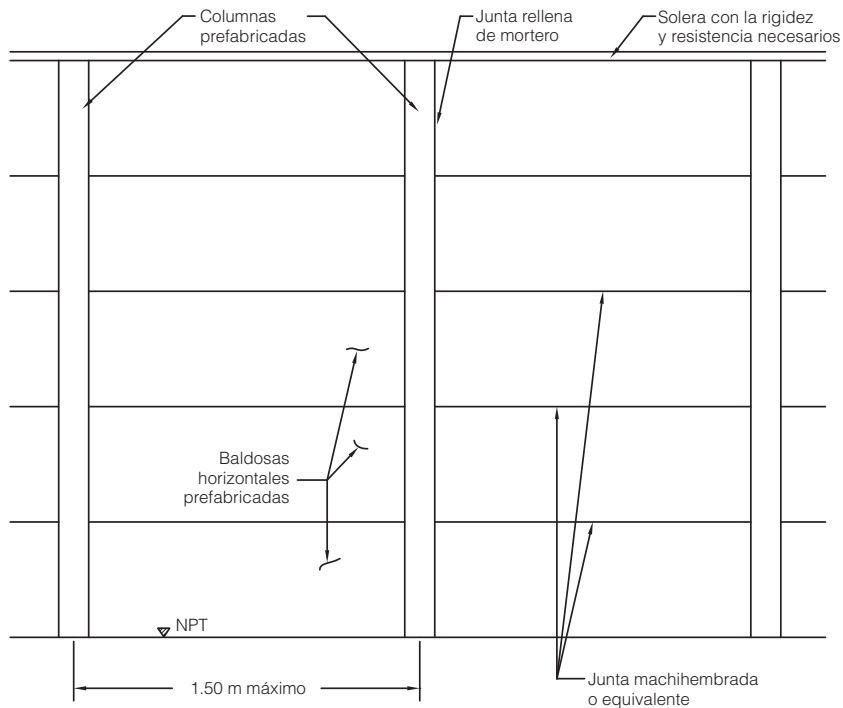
Paredes prefabricadas tipo baldosas horizontales.
